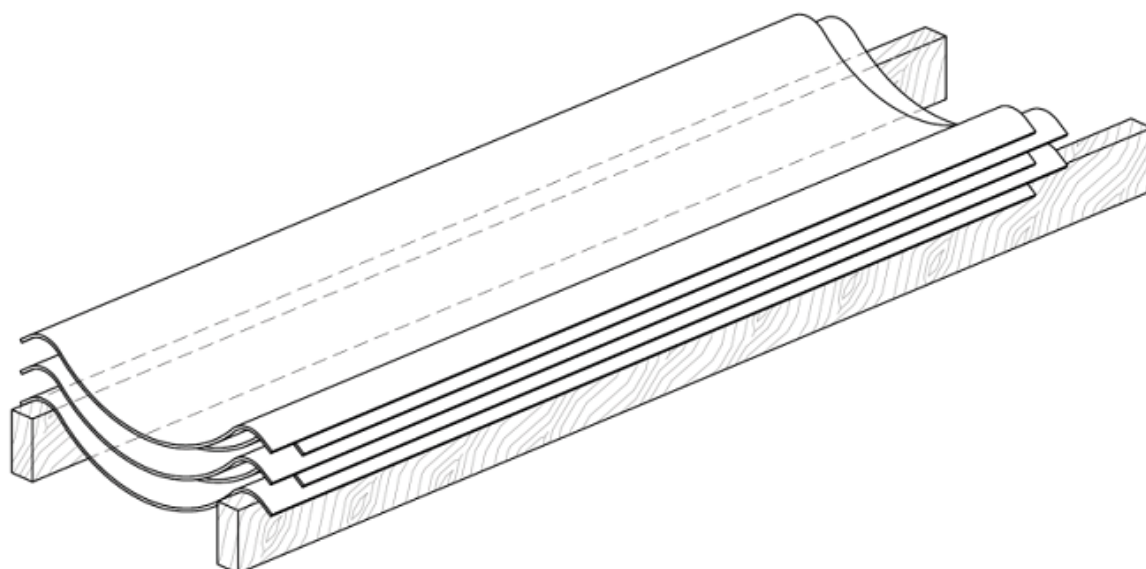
Esquema de empilhamento de telhas tipo canal sobre longarinas Fonte: ABNT NBR 7196.
